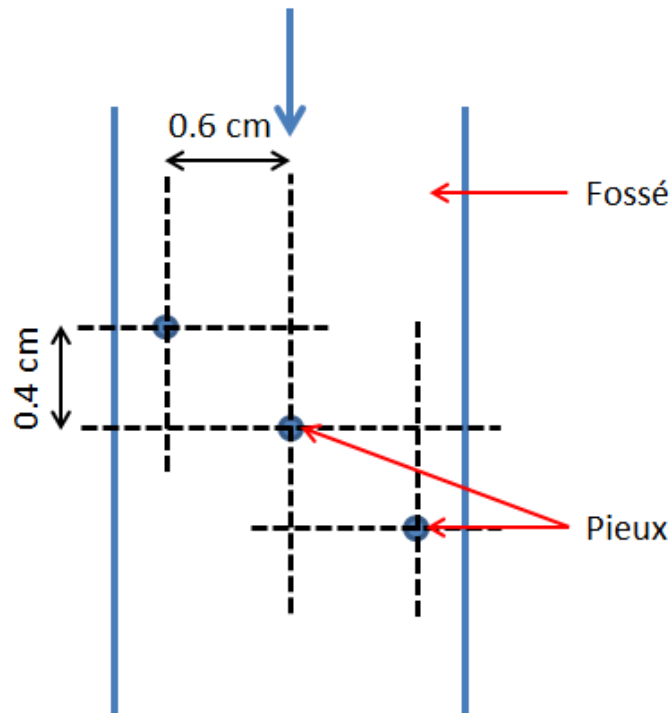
Exemple de la mise en place de pieux possibles en amont du dégrilleur, Servigny-les-Raville
